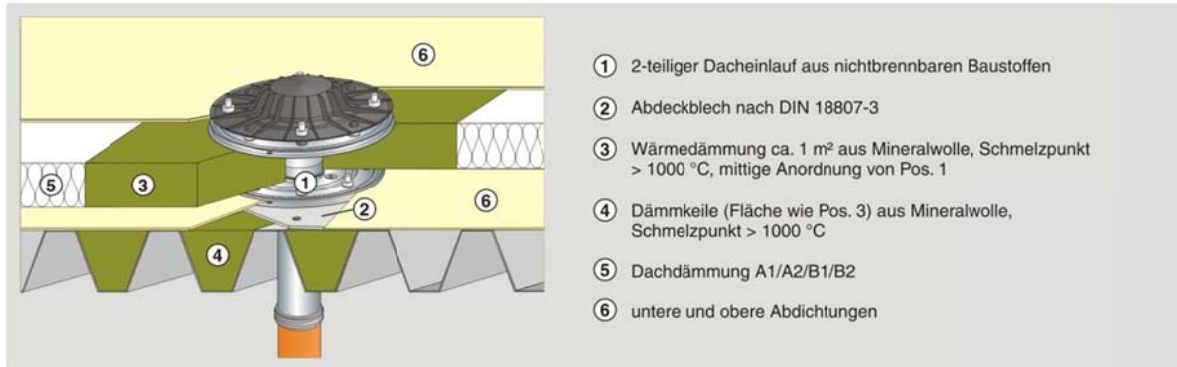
Durchdringung eines großflächigen Daches, z. B. Trapezblechdach mit nichtbrennbaren Rohren / Dachabläufen
